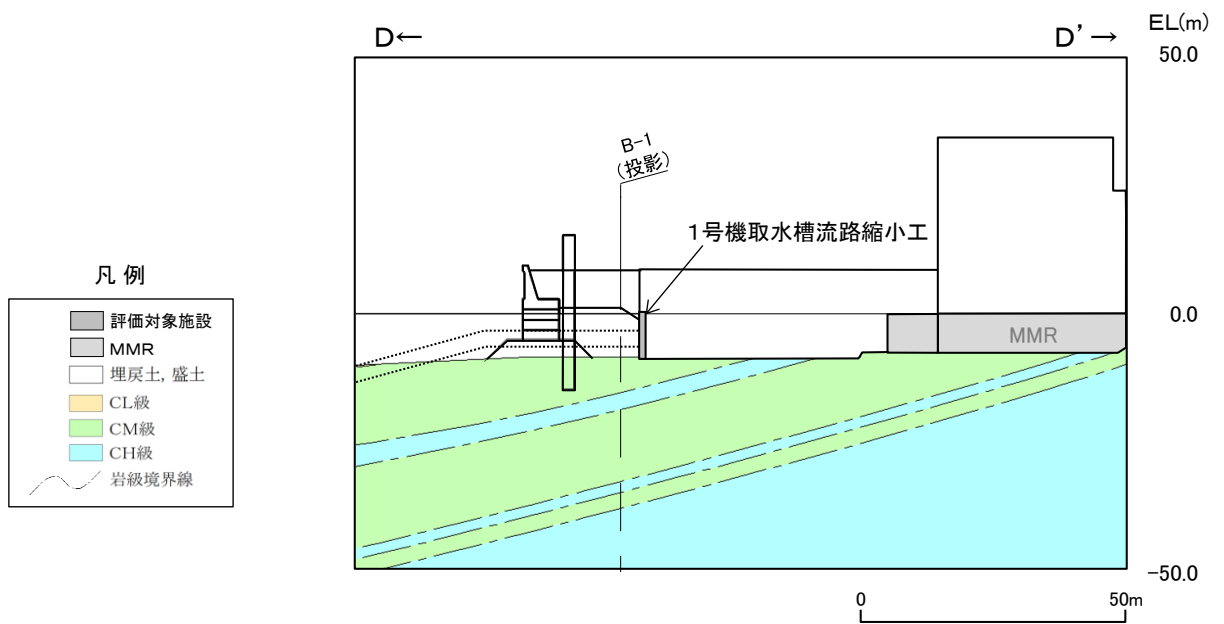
1号機取水槽流路縮小工の地質断面図 (D-D' 断面)
